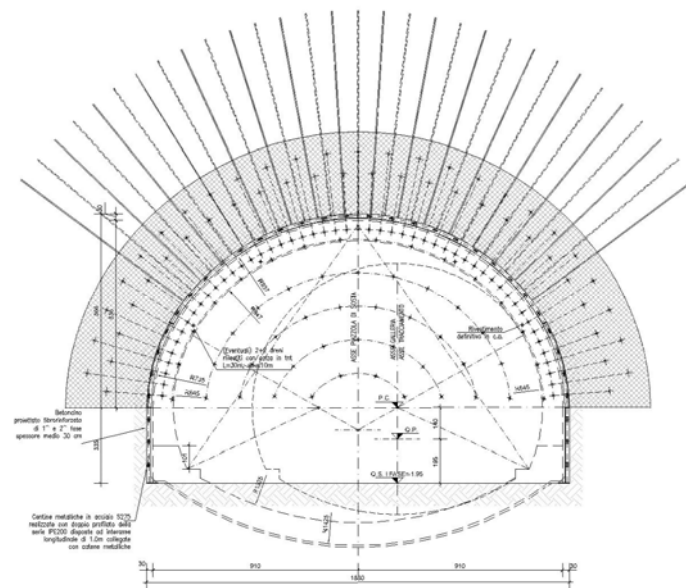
Sezione di scavo tipo GD-PS-B – PIAZZOLA DI SOSTA - Sezione trasversale
